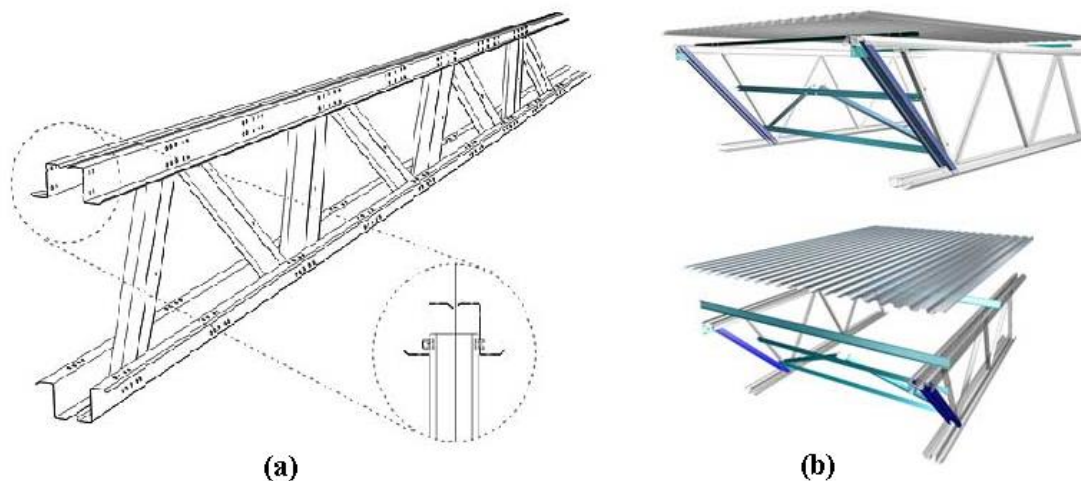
Estruturas de apoio constituídas de PFF: (a) Viga *Universal*® (b) Sistema *Joist in Time*® (MARKO)
